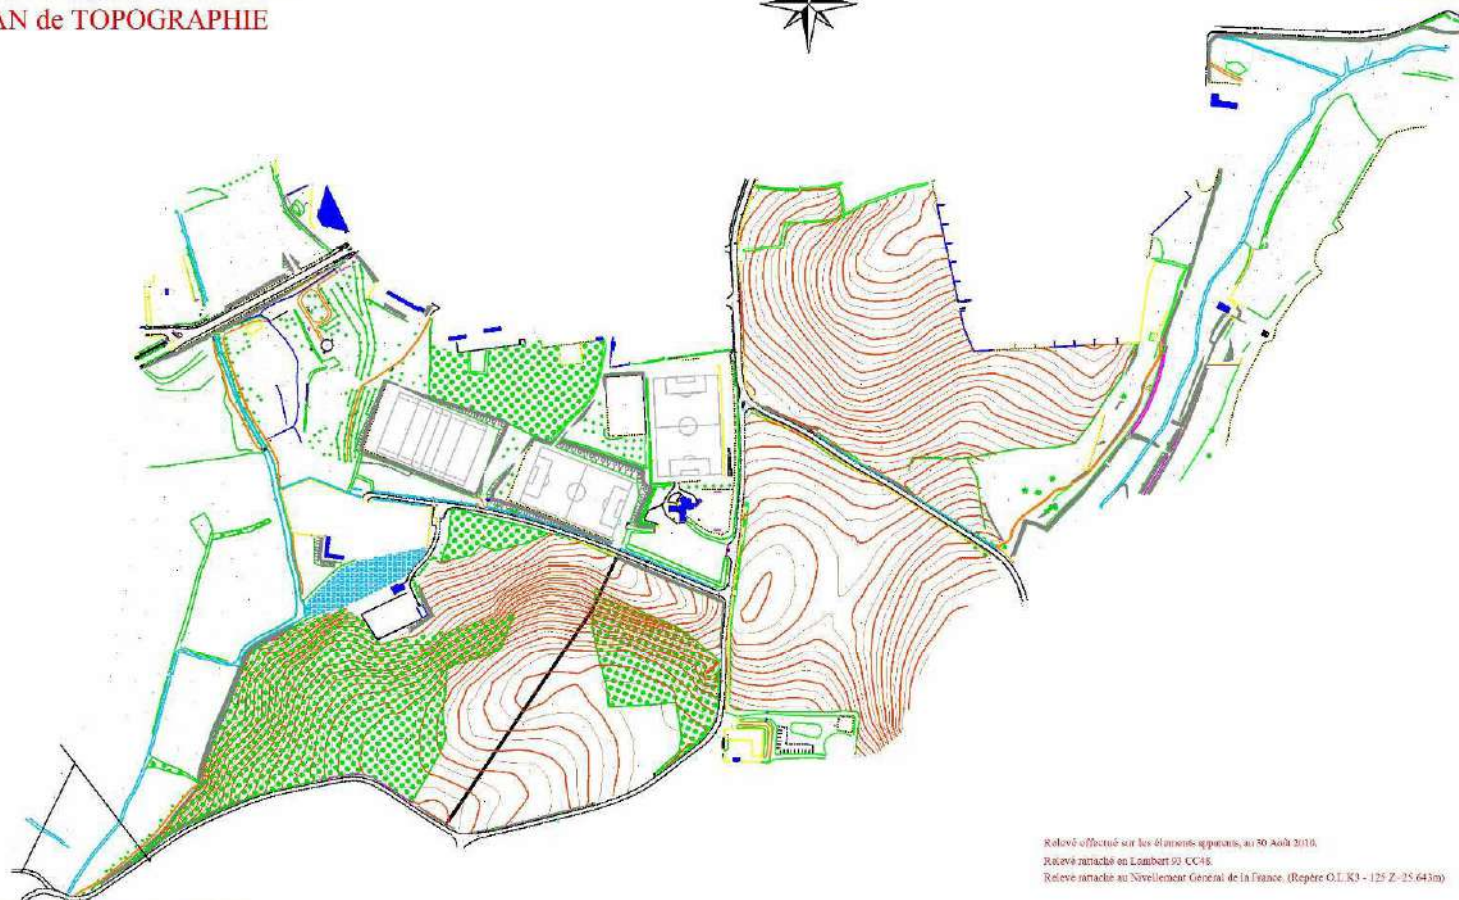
Plan topographique du secteur de la Saudraye (hors échelle)
